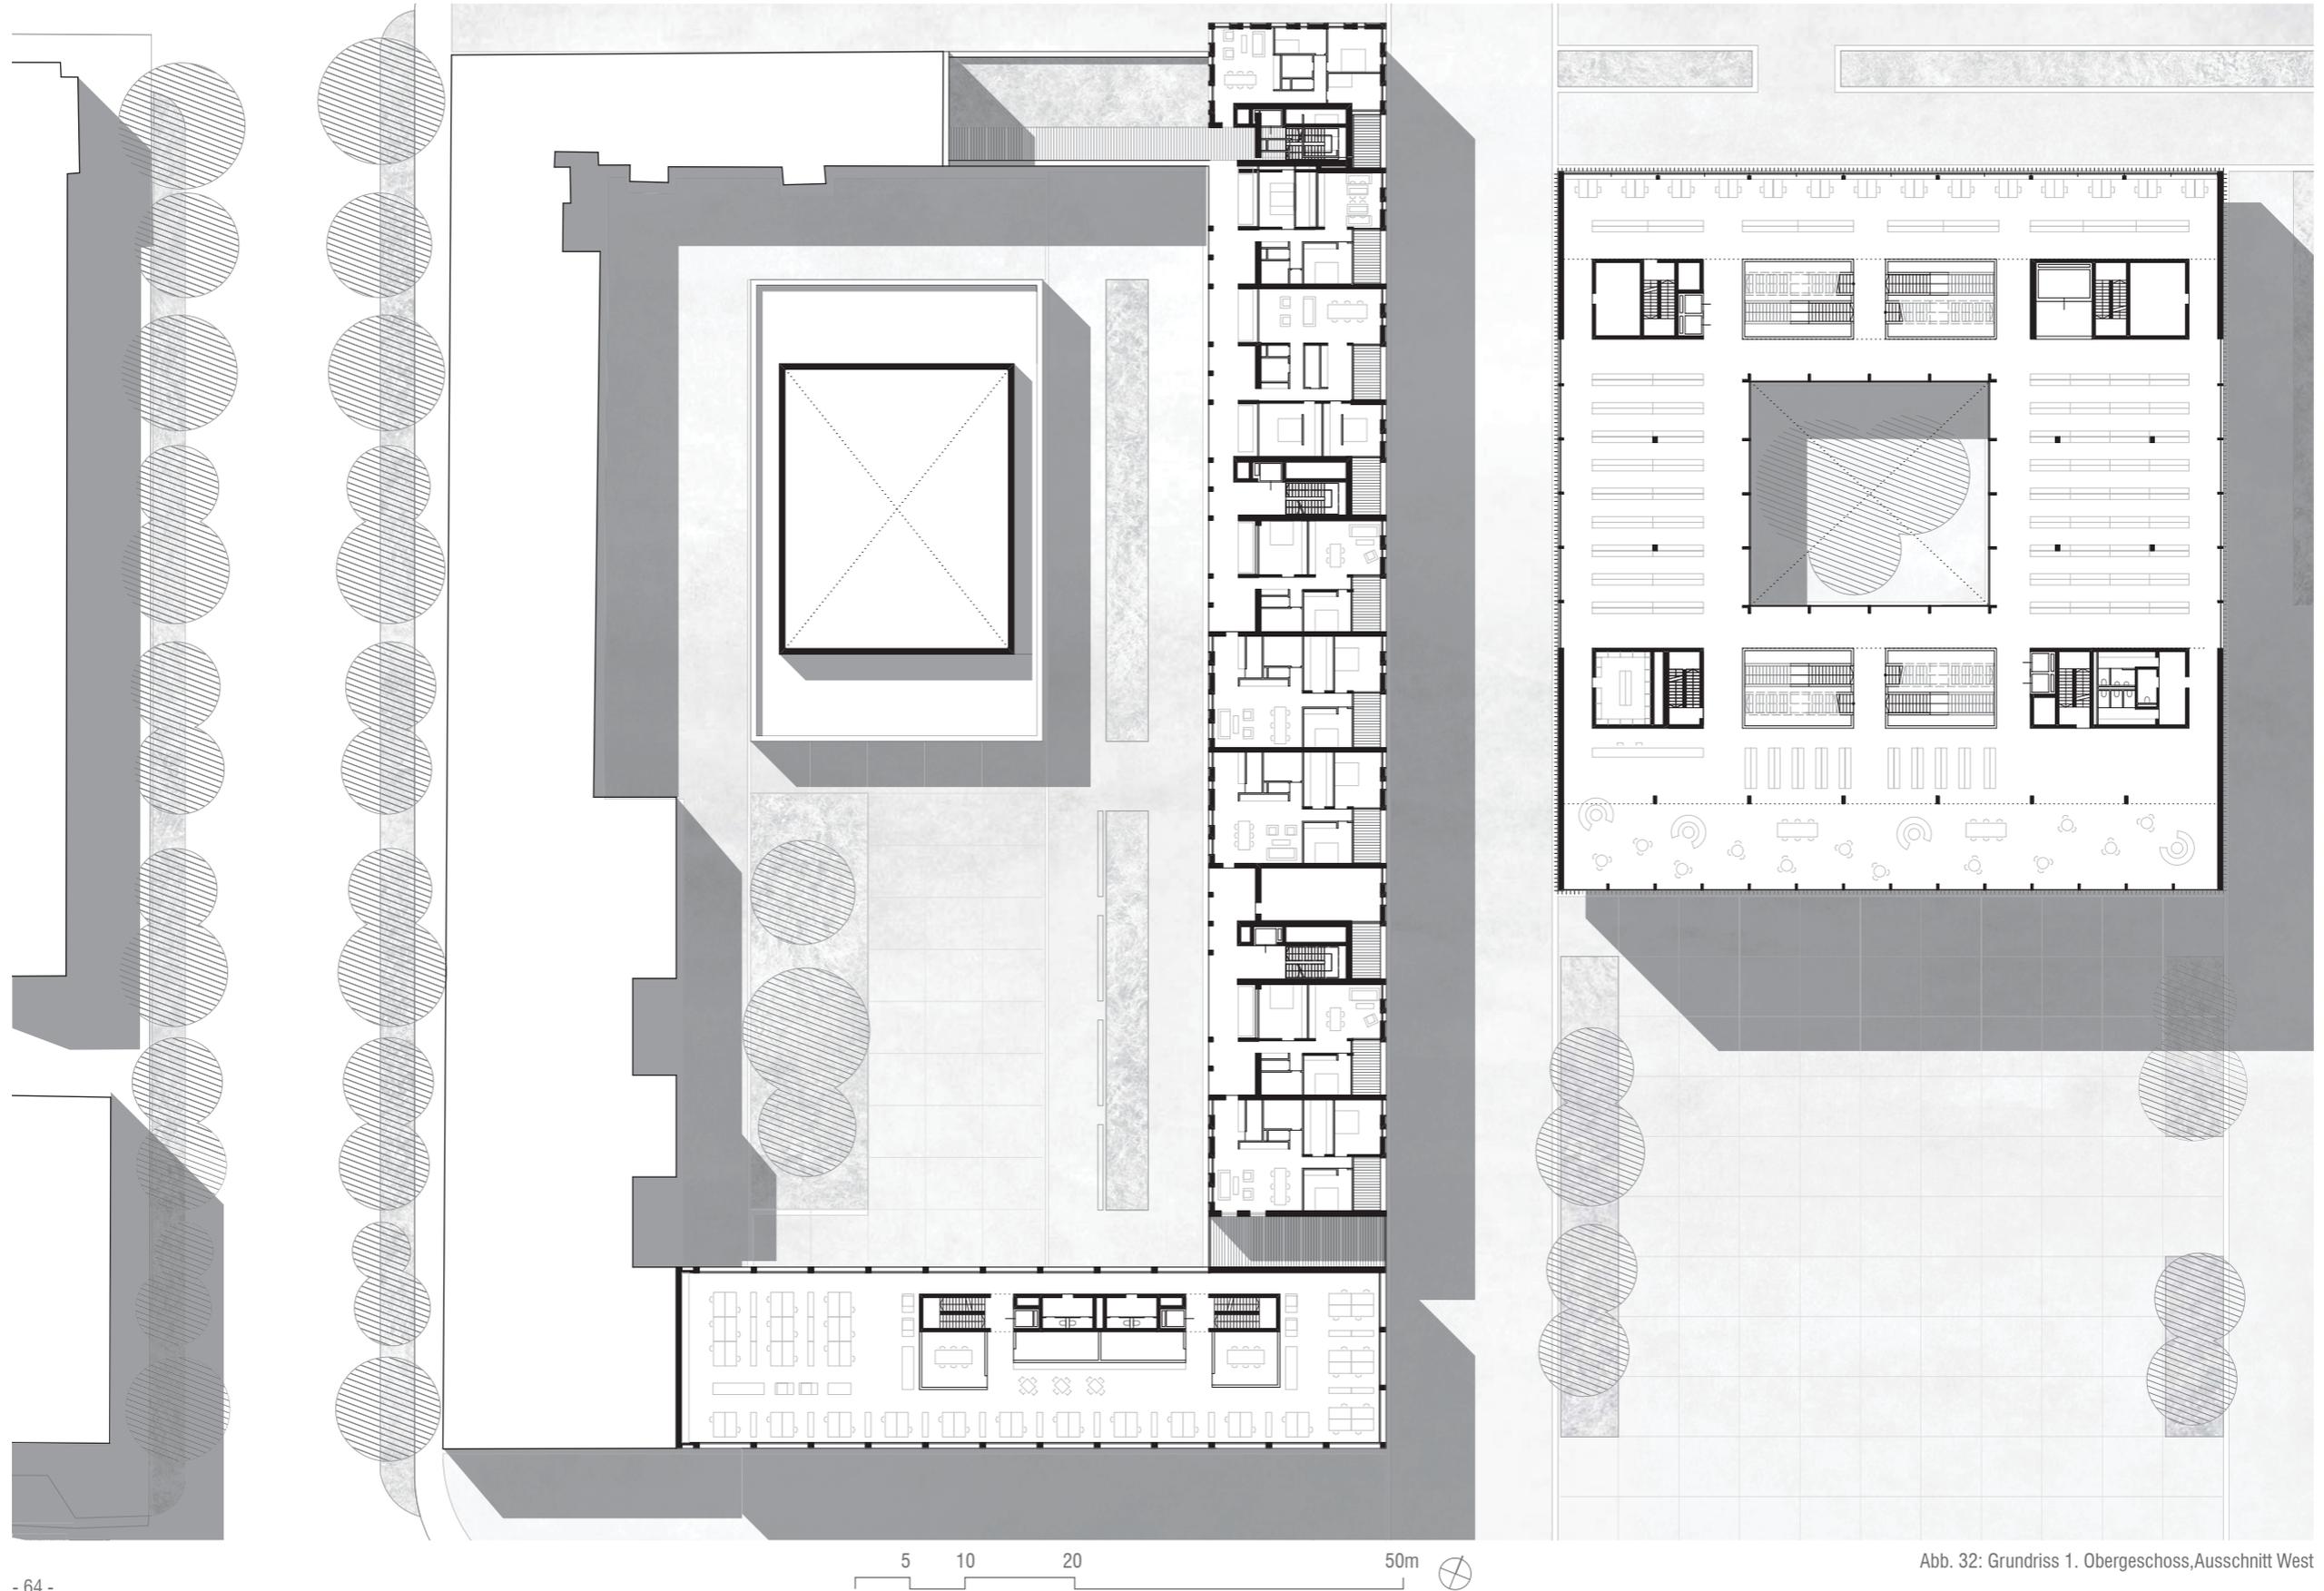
Grundriss 1. Obergeschoss, Ausschnitt West
